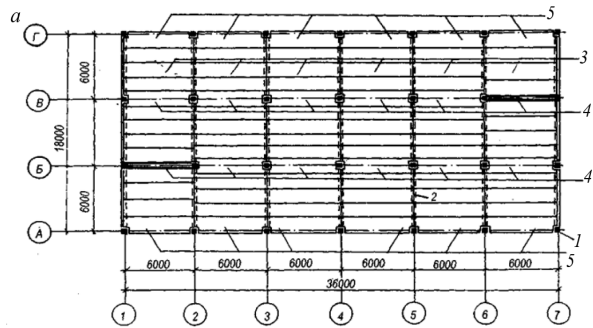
Ригелі рам збірного залізобетонного зв'язкового каркаса:
